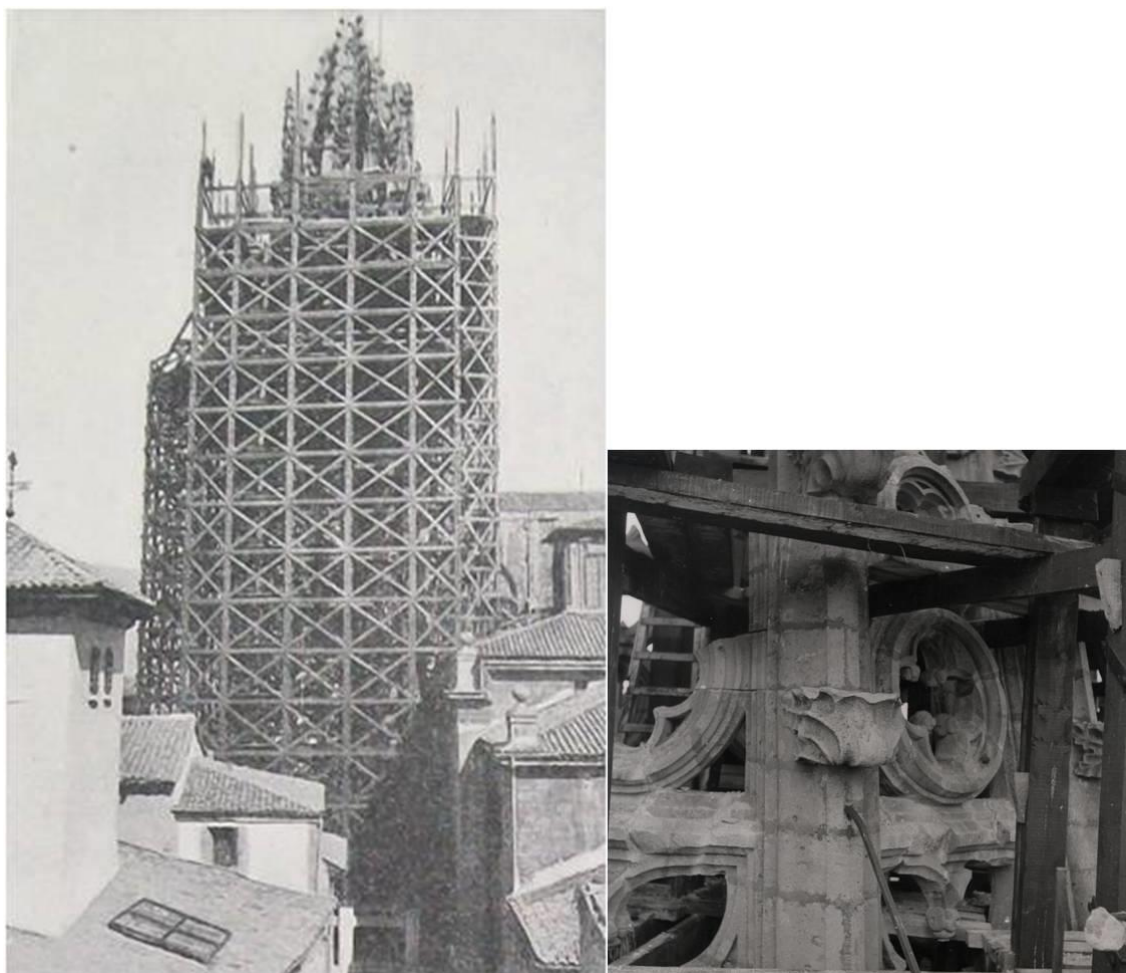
Izda: andamio de la torre de la catedral de Oviedo. Reconstrucción, n.º 21, 1942. Dcha: detalle de la reconstrucción de las tracerías de la flecha. AGA. F-04227-024-002.
